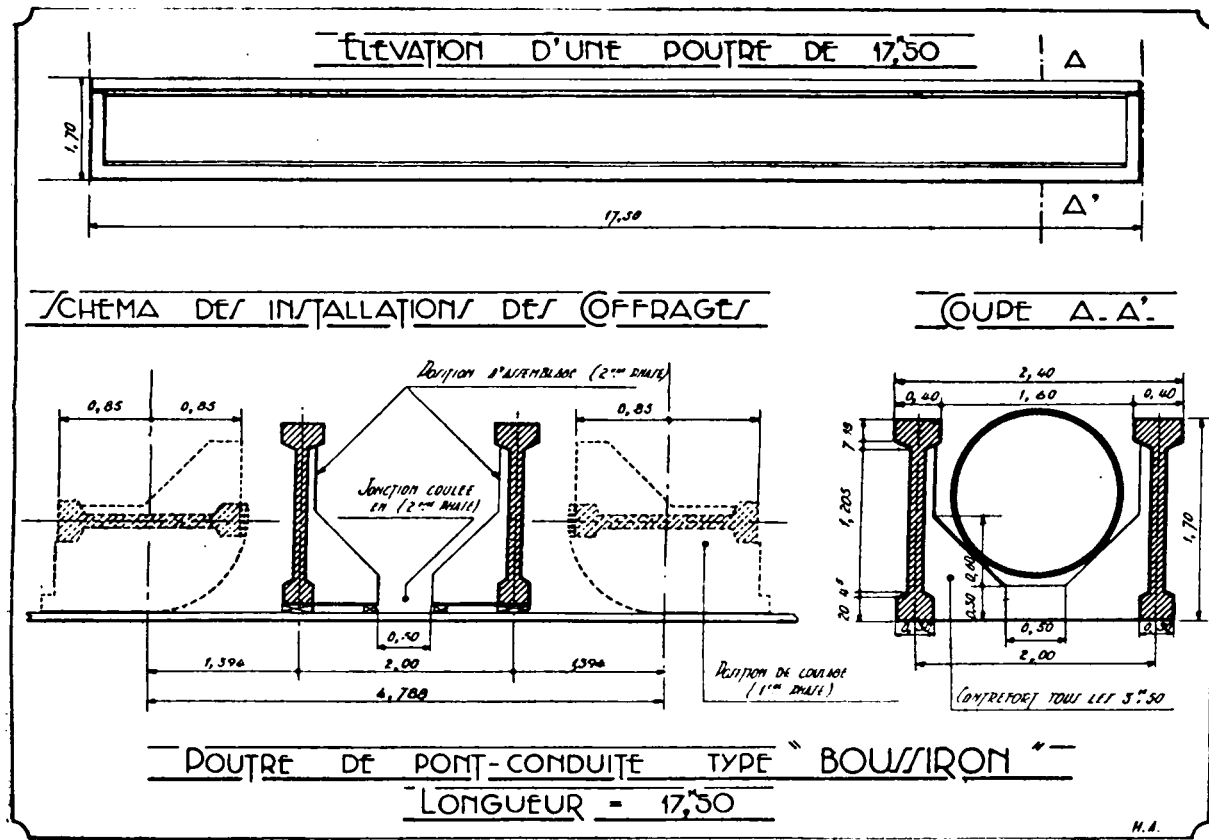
Poutre de 17 m. 50 (Boussiron)
